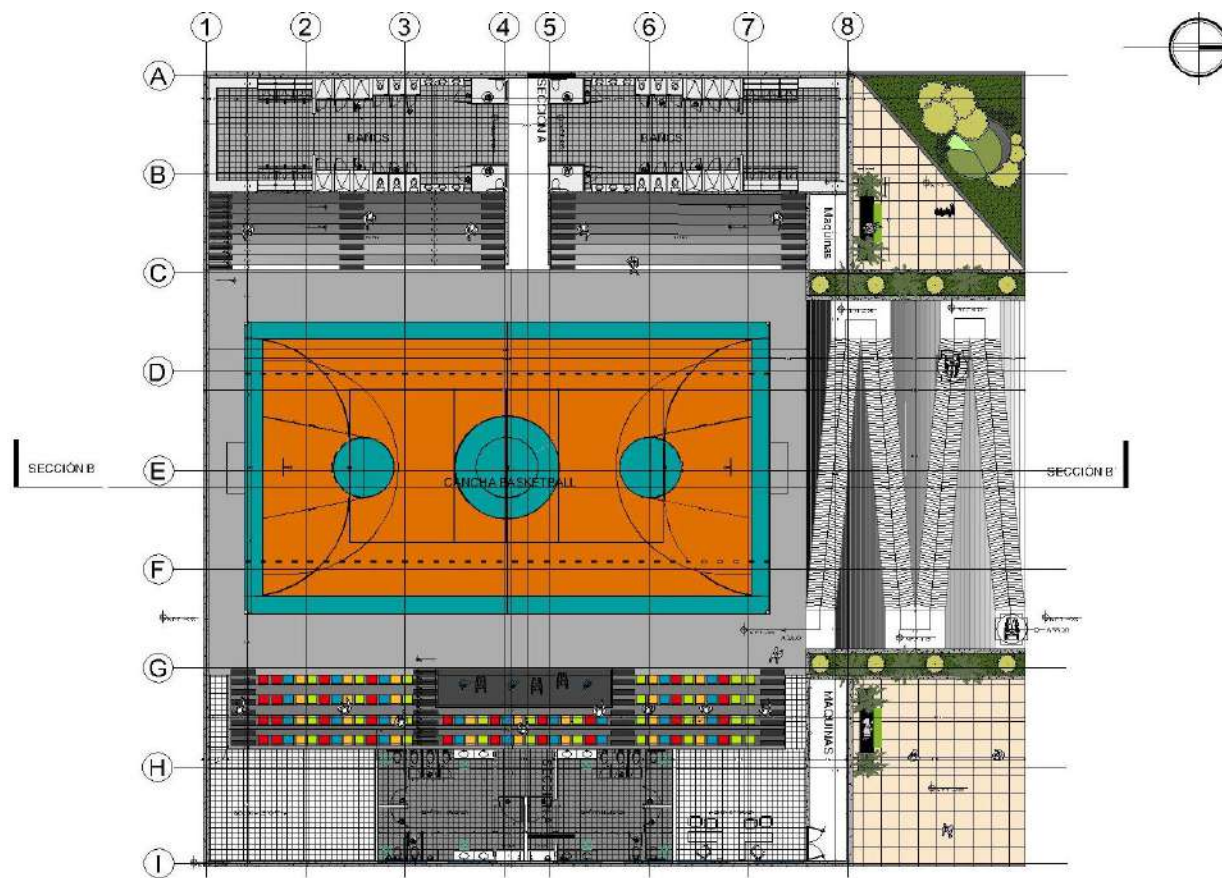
Planta arquitectónica, cancha de baloncesto: Fuente: Elaboración propia 2021.
